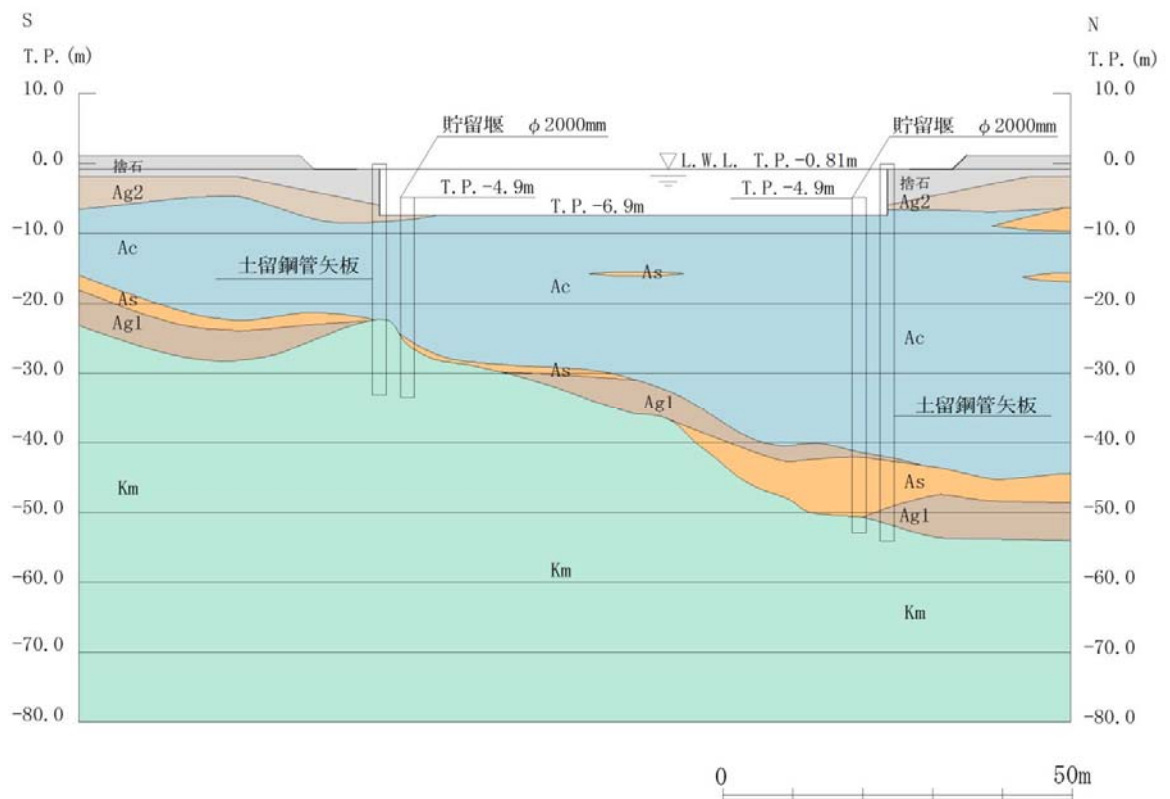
土留鋼管矢板の断面図 (NS-1)
